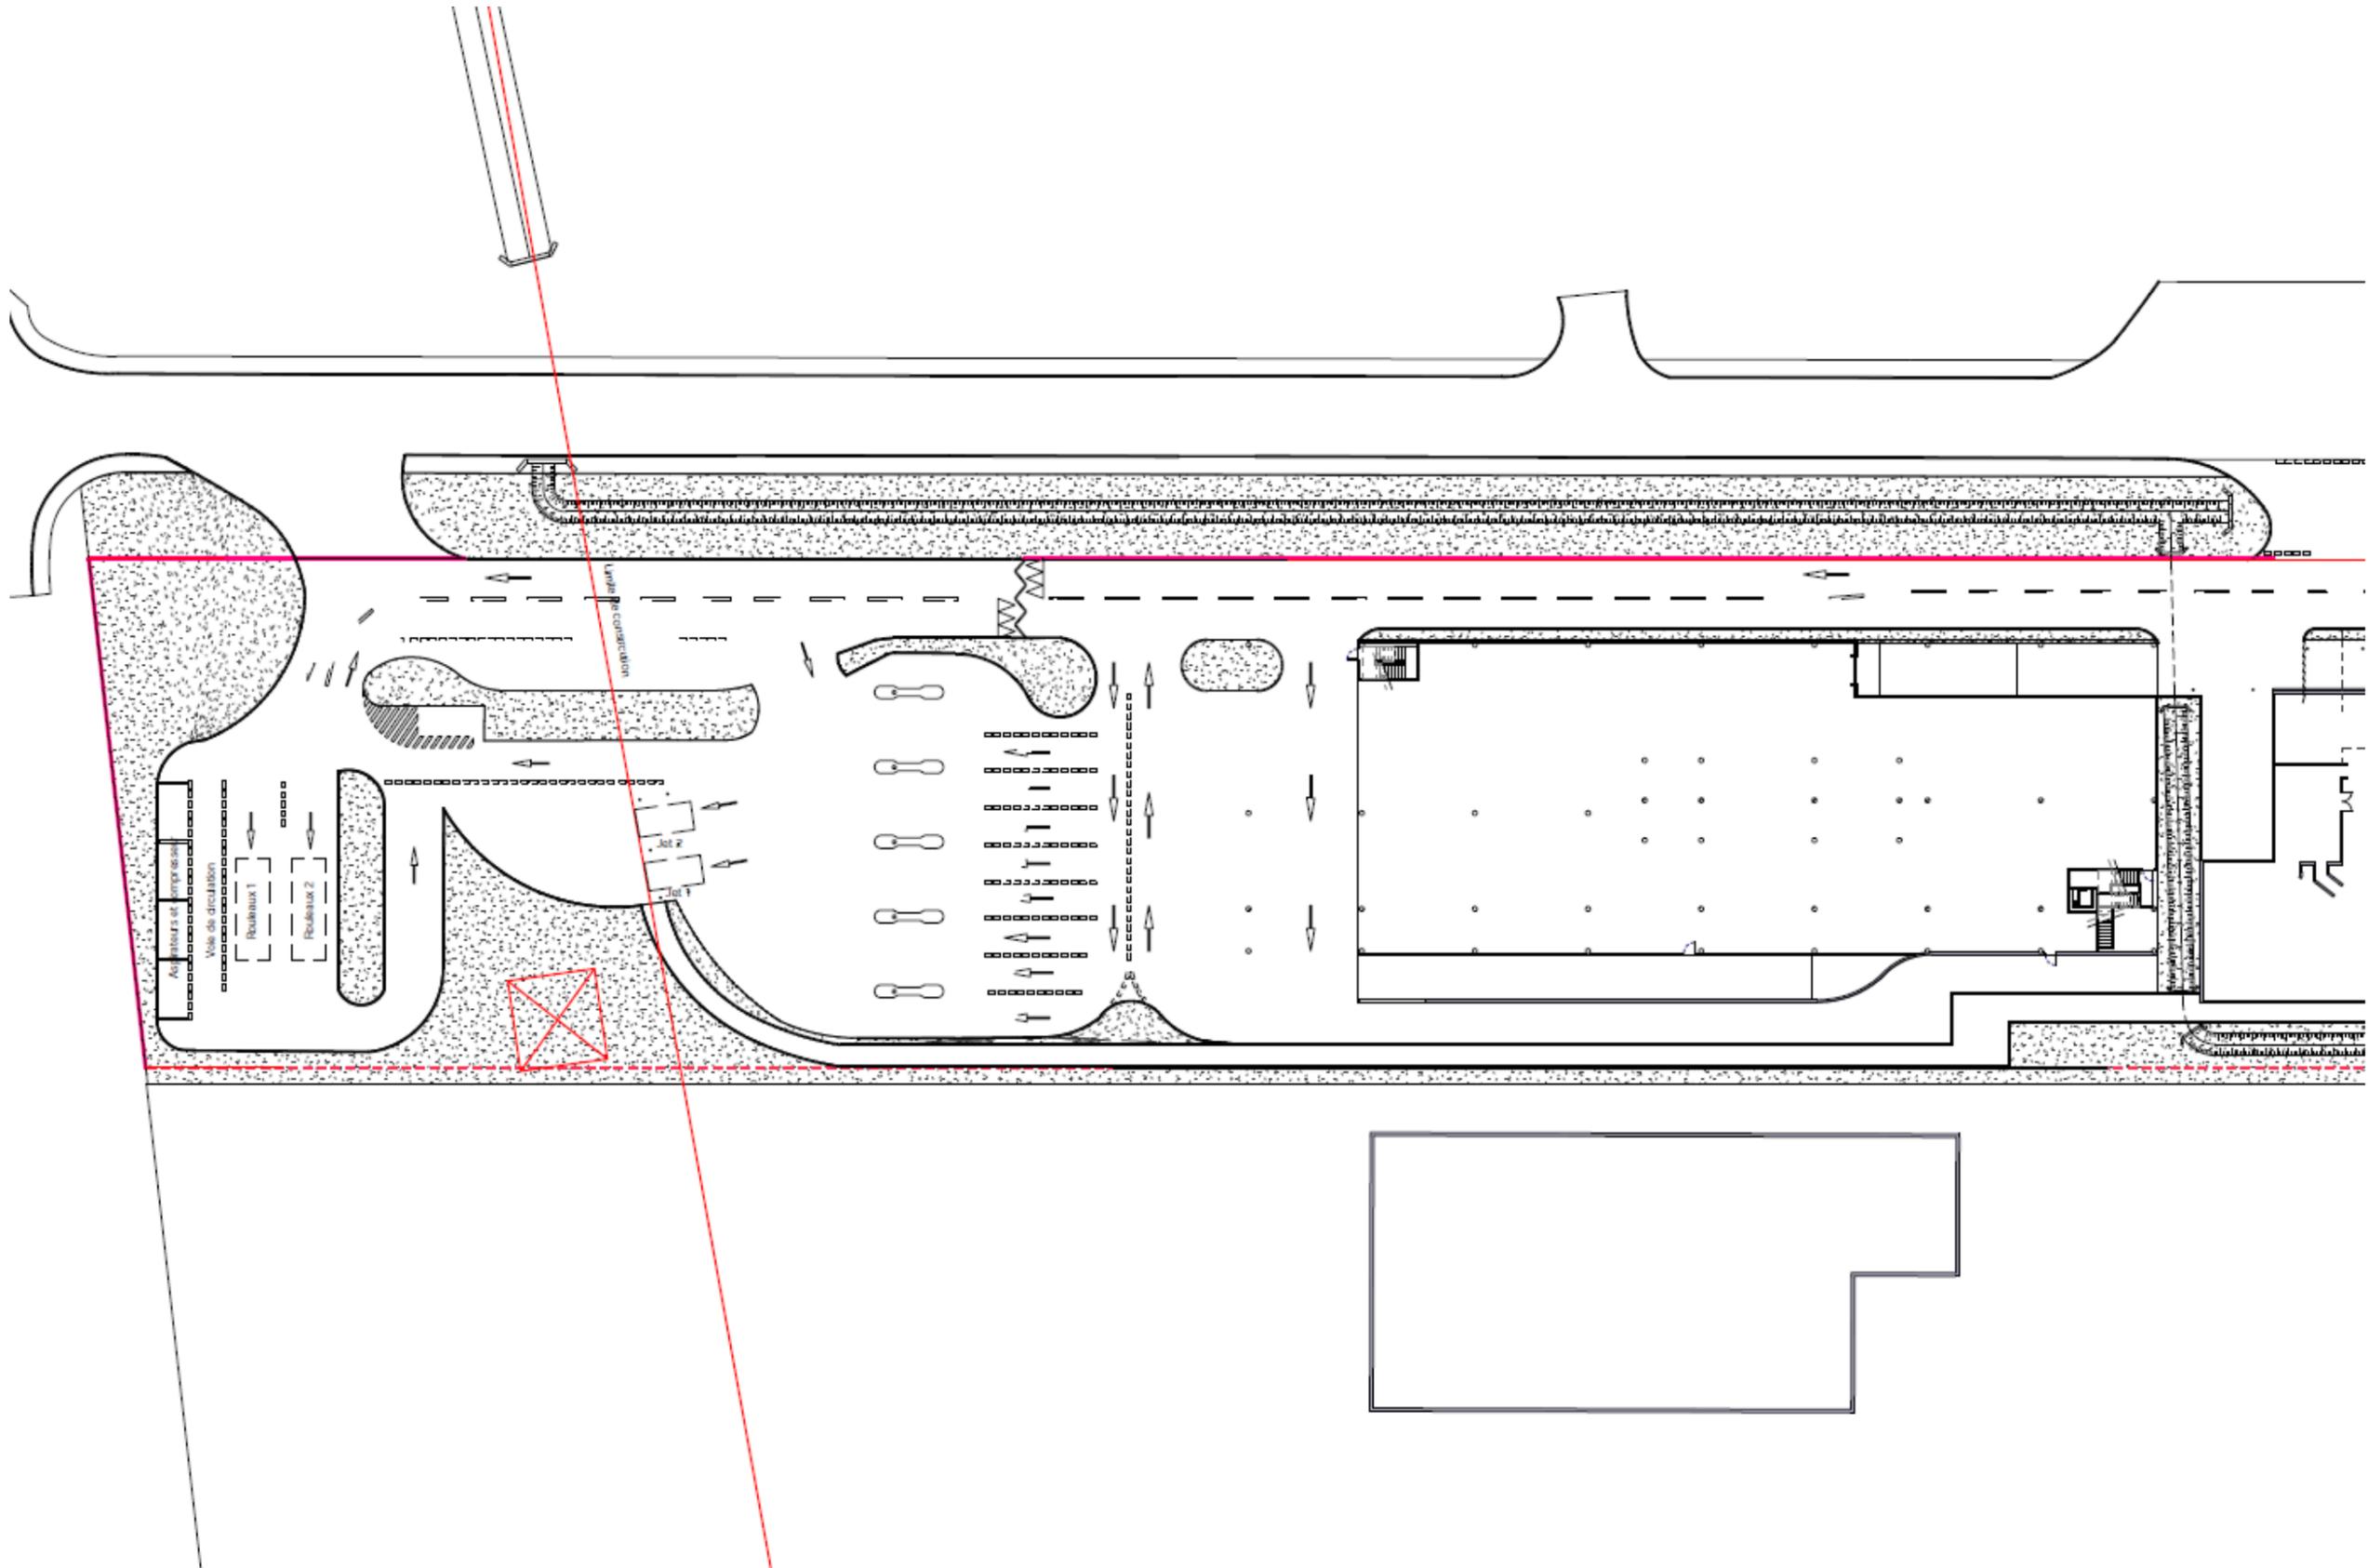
Plan de masse du projet – zoom sur la station de lavage (Source : REC Architecture)
